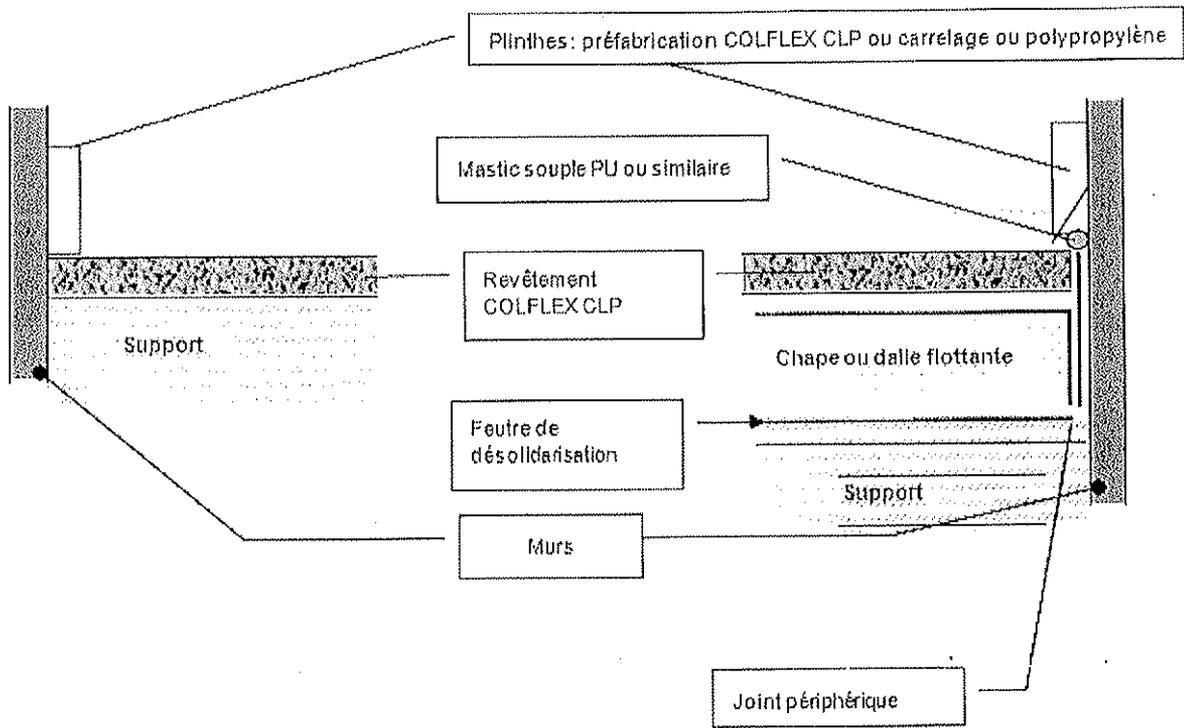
Traitement des rives – Cas courant E2 (y compris sur dalle ou chape flottante)
